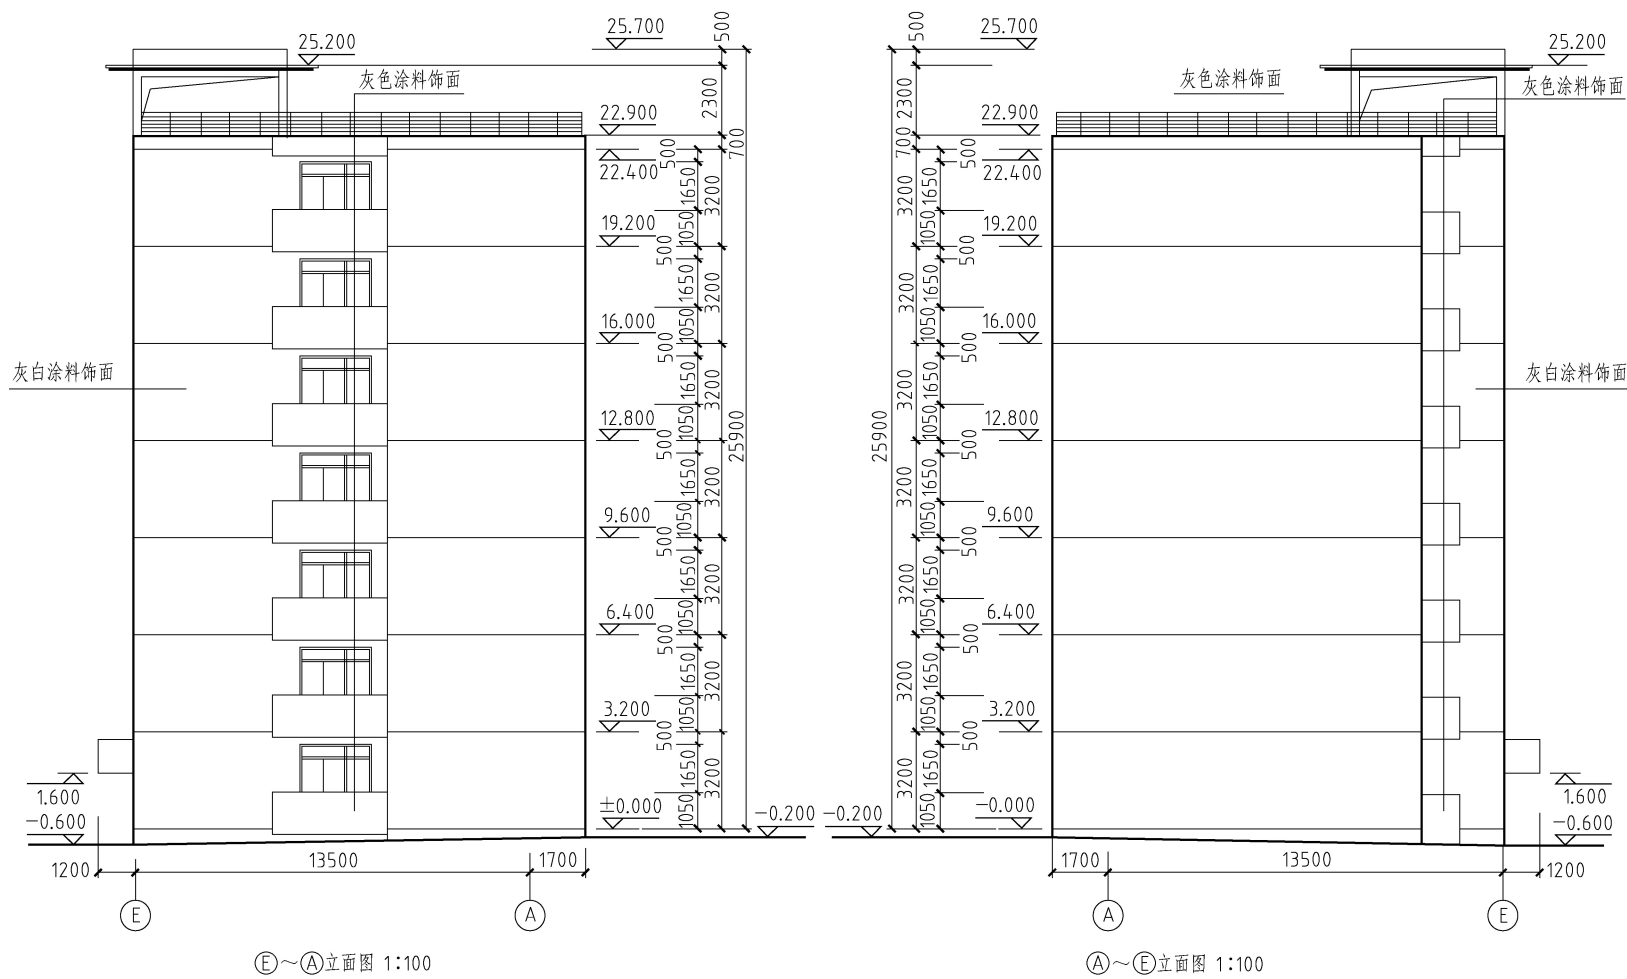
学生宿舍楼 (E)~(A) 立面图和 (A)~(E) 立面图
